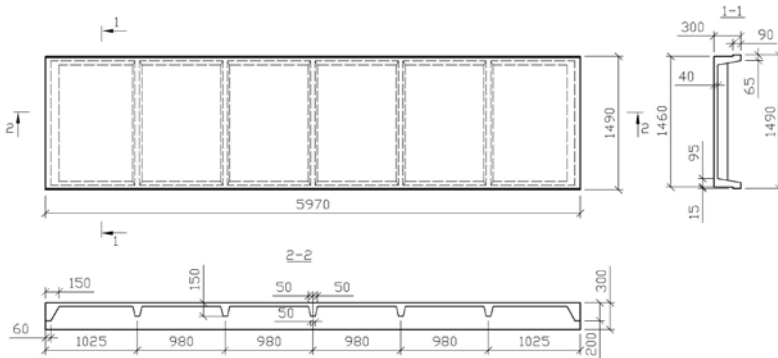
Конструкция плиты покрытия размером 1,5×6 м
